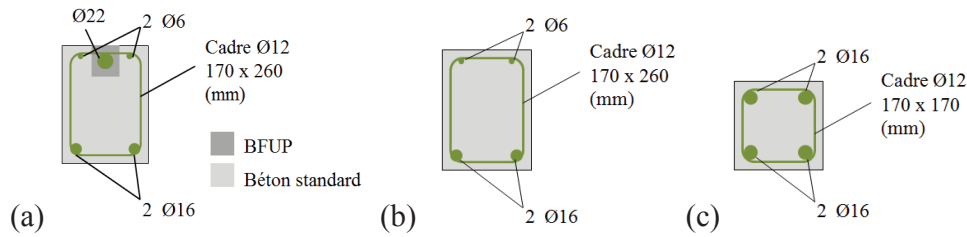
Renforcements de la section (a) aux appuis, (b) en travée de la poutre et (c) du poteau du portique G3
